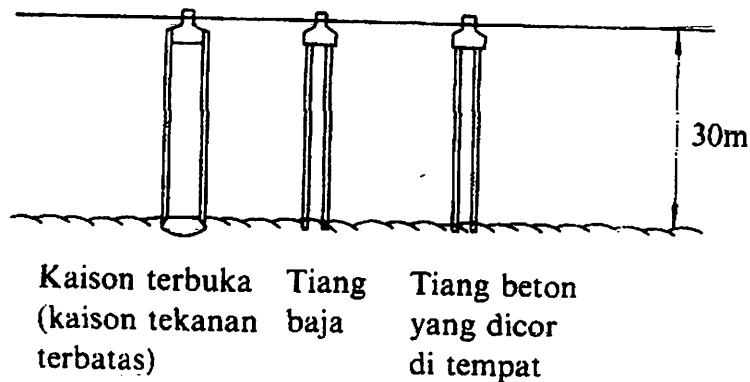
Contoh pondasi bila lapisan pendukung pondasi berada sekitar 30 m di bawah permukaan tanah. (Sumber: Soedarmo, 2002 dan Nakazawa, 2000: 76)
